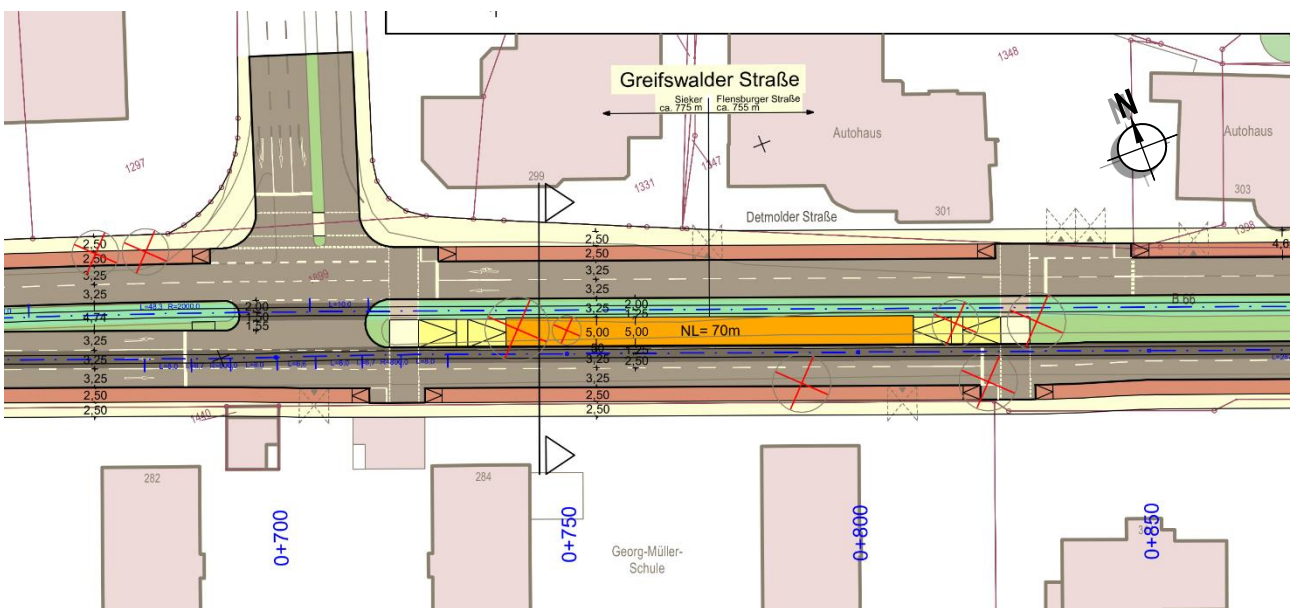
Trassenvariante 1 – Lageplan Detmolder Straße Haltestelle Greifswalder Straße
